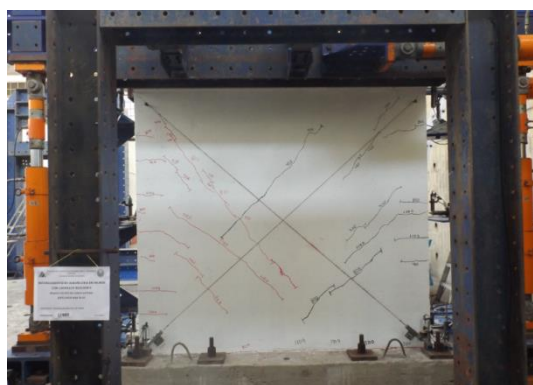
Aumento de grietas diagonales para una distorsión 1/400.
